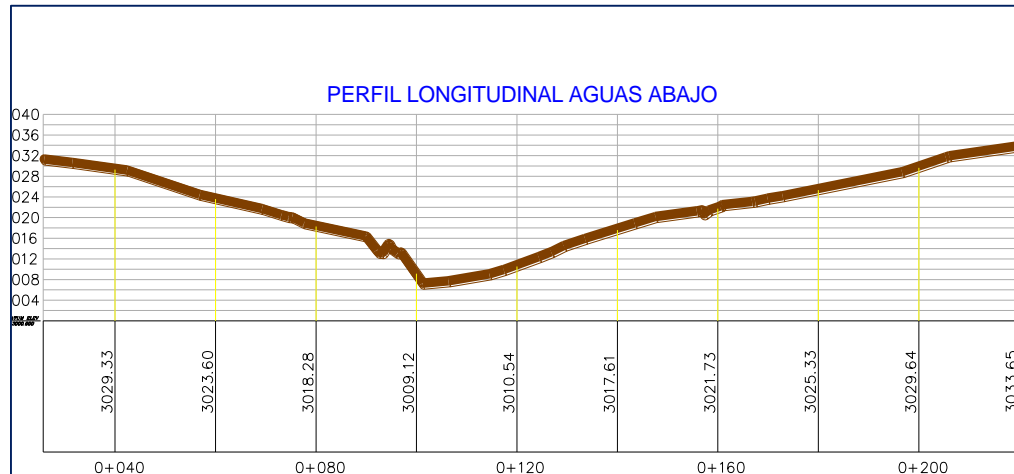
perfil longitudinal en lugar de emplazamiento del puente.
